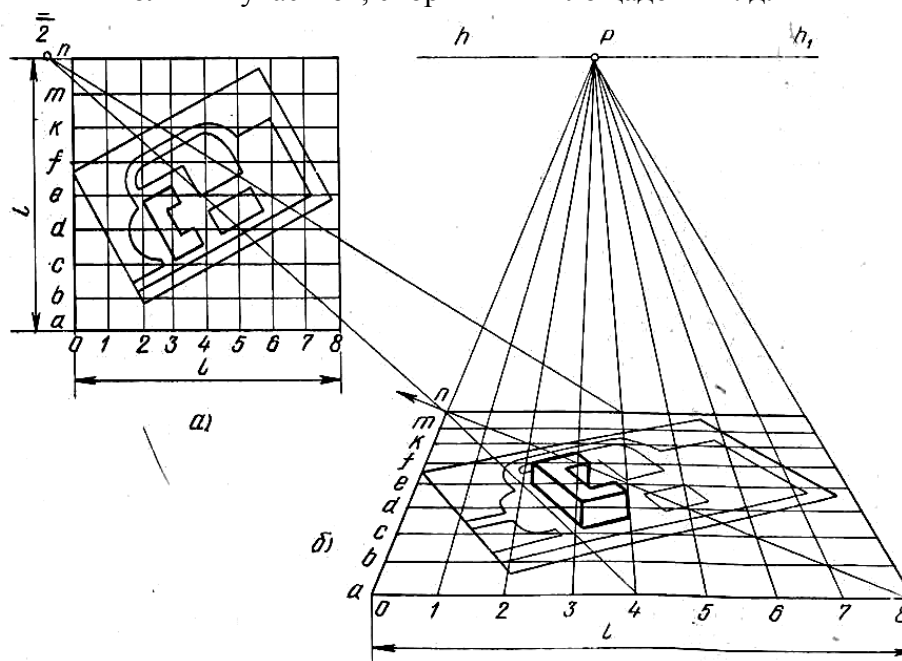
Построение плана садового участка при помощи перспективных масштабов координатной сетки. На рисунке 16,а задан план некоторого садового участка, который необходимо построить в перспективе. План участка разбивают на квадраты. В данном примере участок разбит на 64 квадрата. В перспективе для большей наглядности квадратную сетку обычно увеличивают в два или большее число раз. Выбирают высокий горизонт и строят перспективу квадрата. На плане стороны квадрата делят на части и обозначают буквами или цифрами. Затем с помощью перспективных масштабов строят перспективу квадрата. Данный квадрат в перспективе увеличен в два раза. Перспективу сторон квадрата делят на восемь равных частей и строят перспективную сетку (рис. 16, б).
